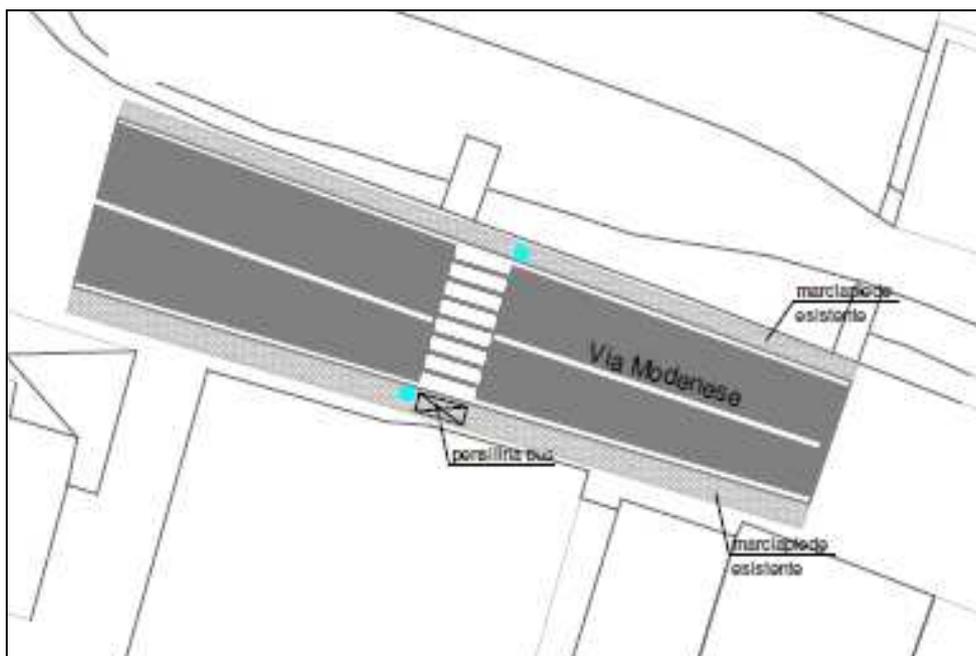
Stato di Progetto Via Modenese – Loc. Cireglio - Planimetria
